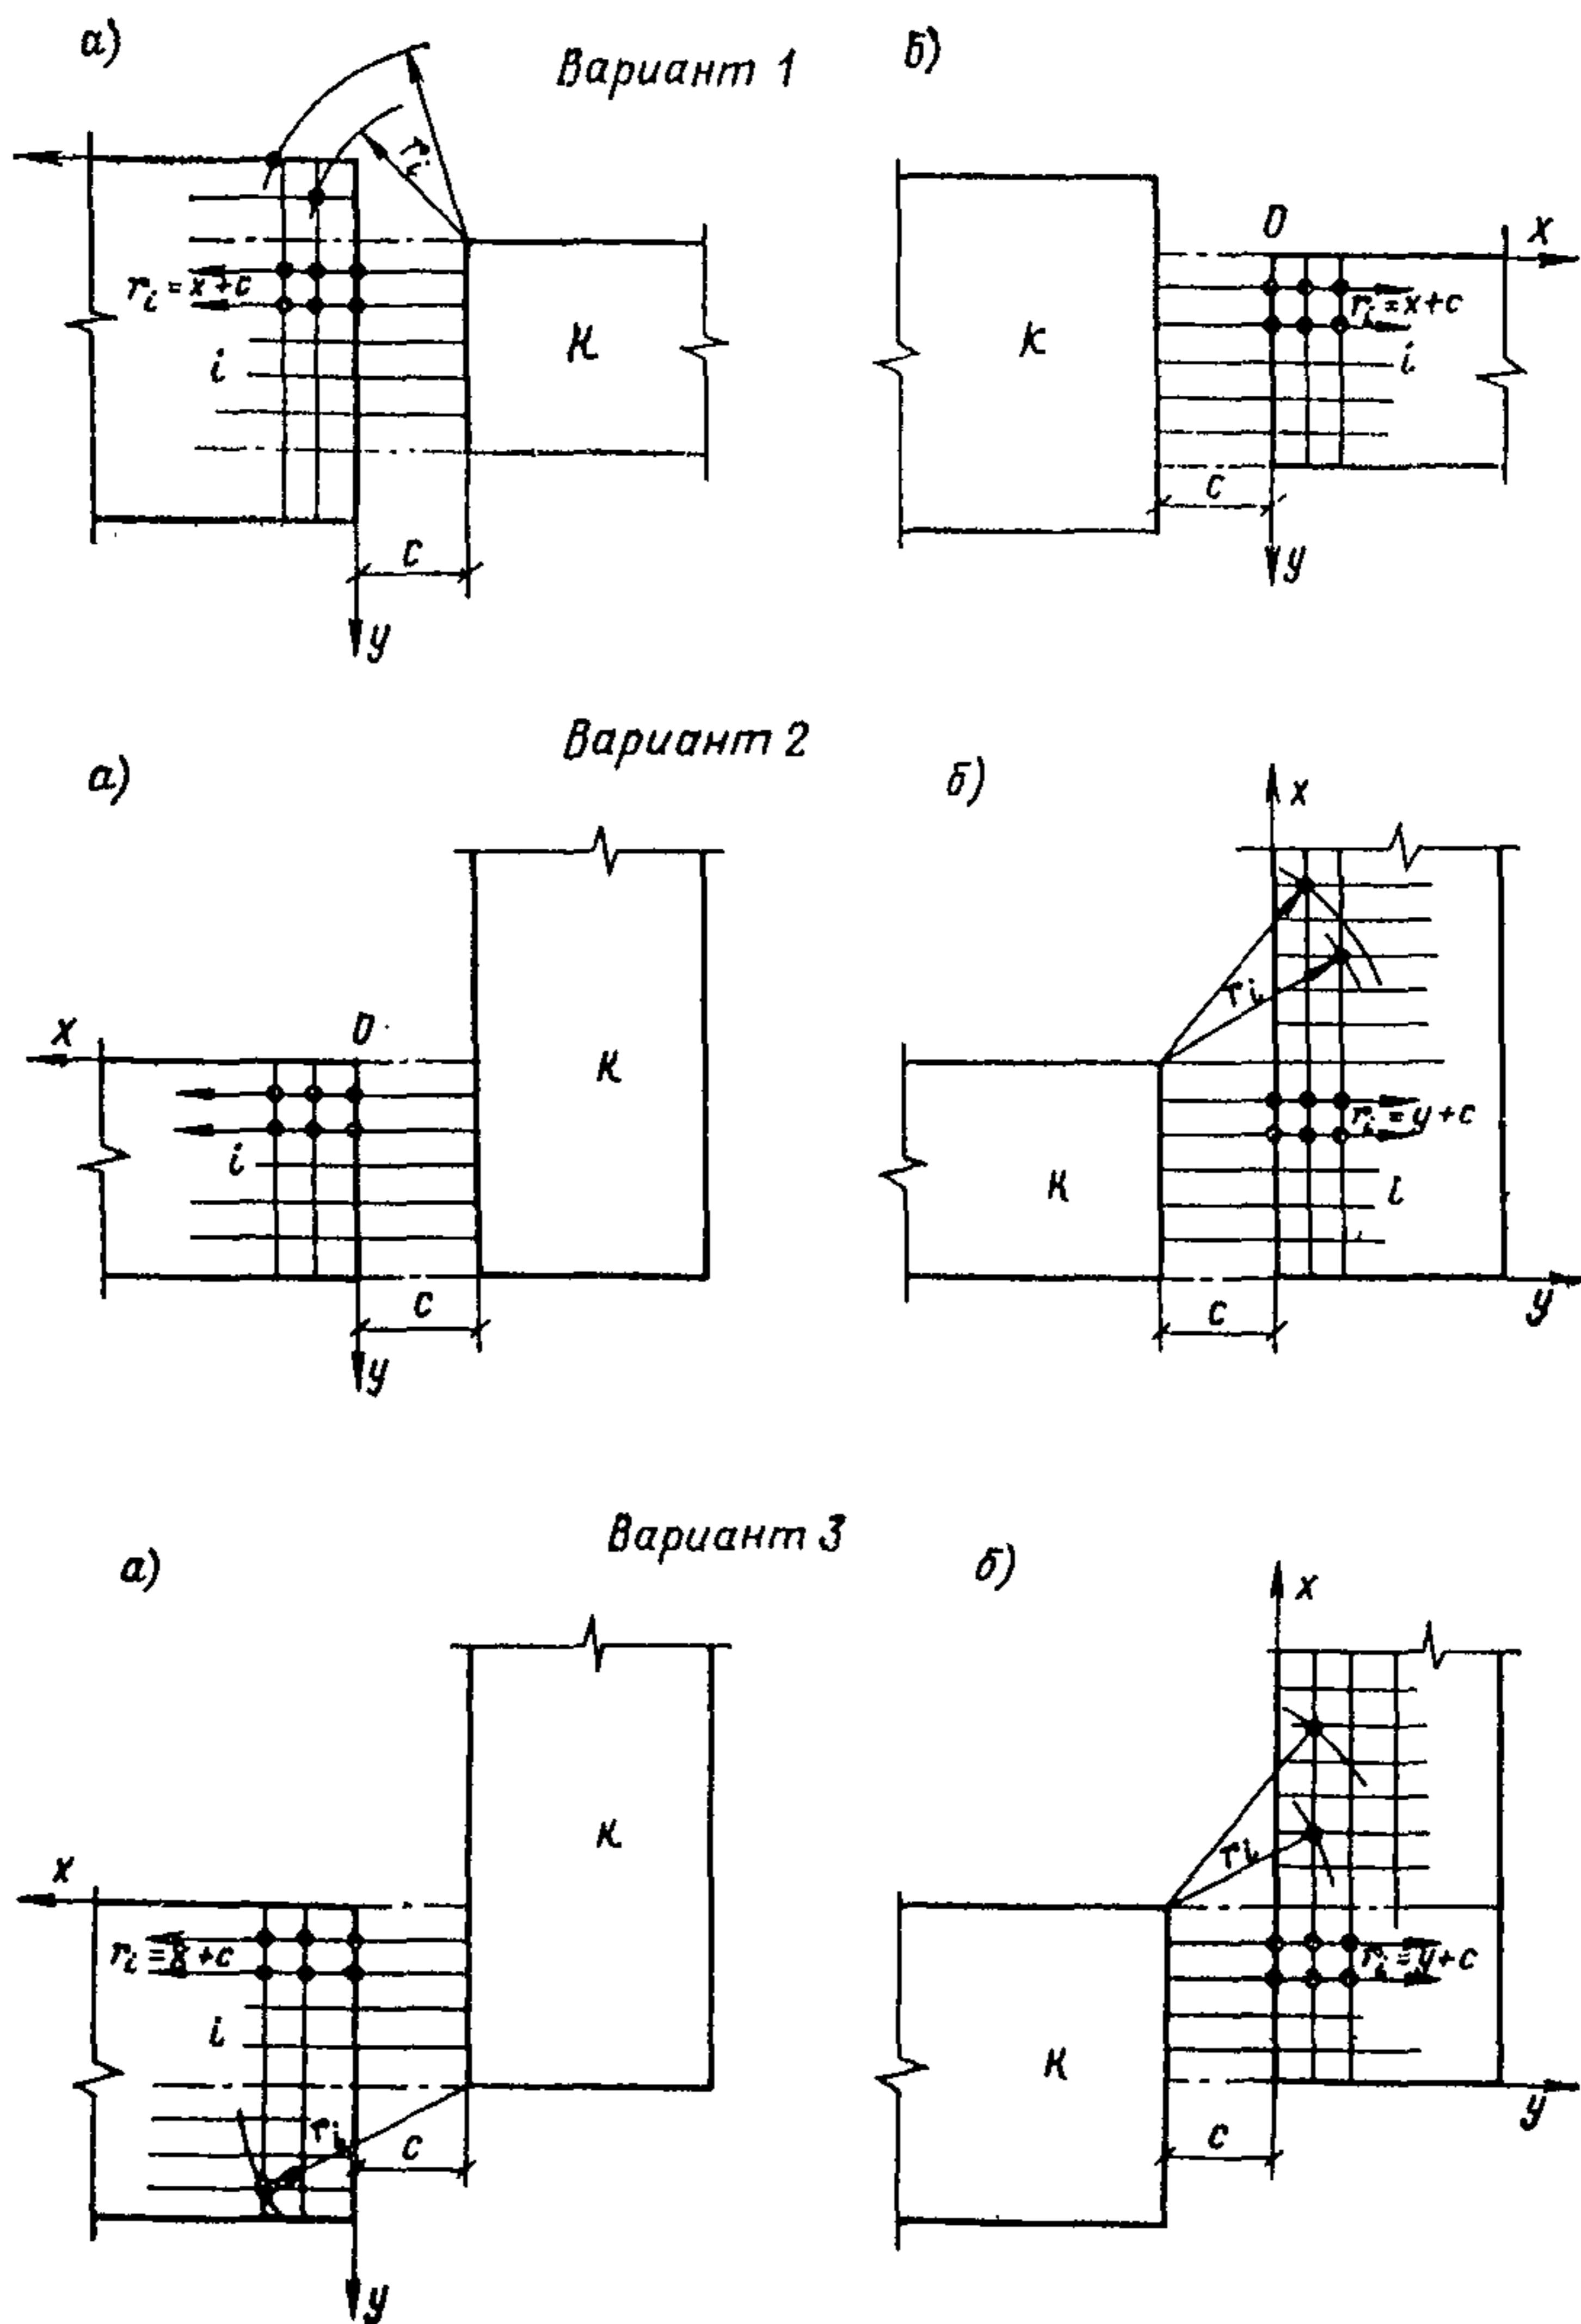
Схема относительного расположения фундаментных плит (варианты 1—3)
